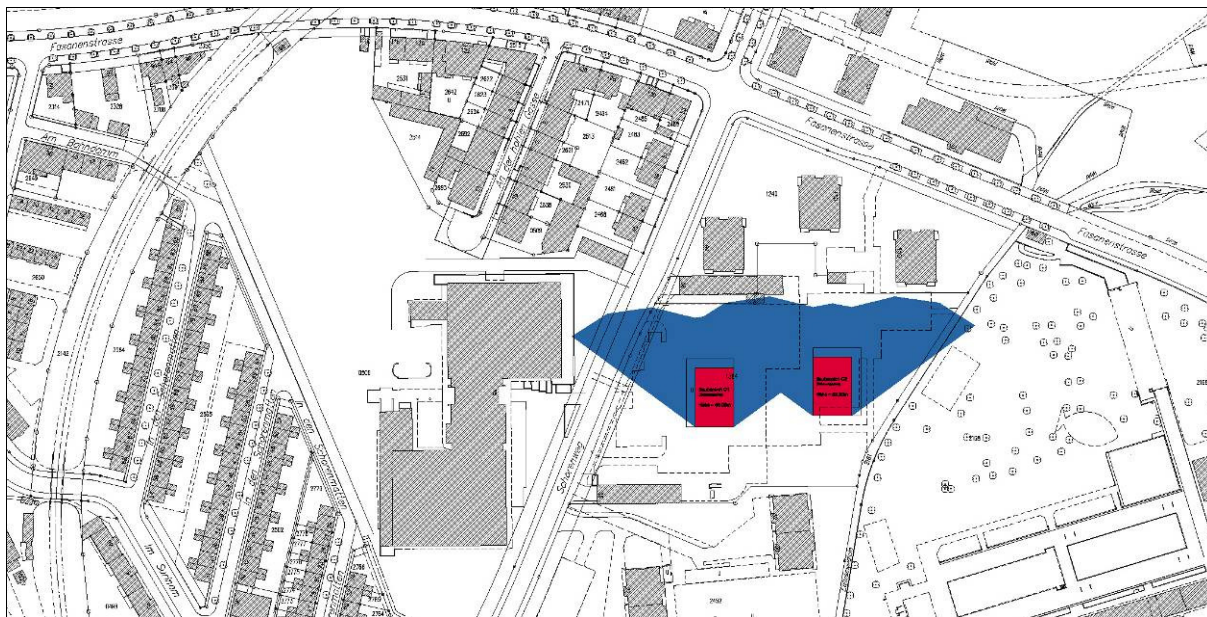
2-Stunden Schatten. (ohne Massstab, Plan genordet)
